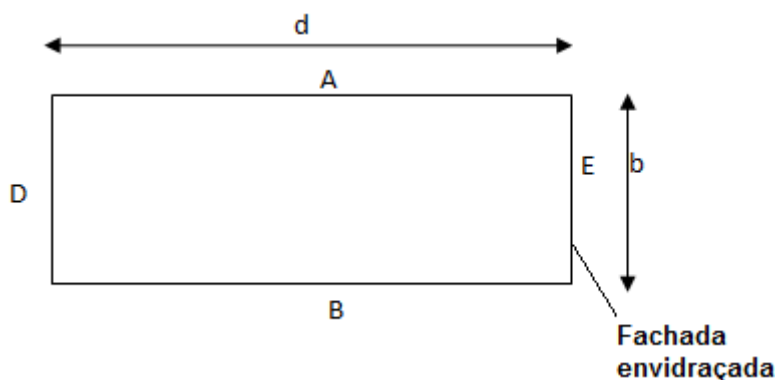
Denominação das fachadas do Teatro de Camões.
